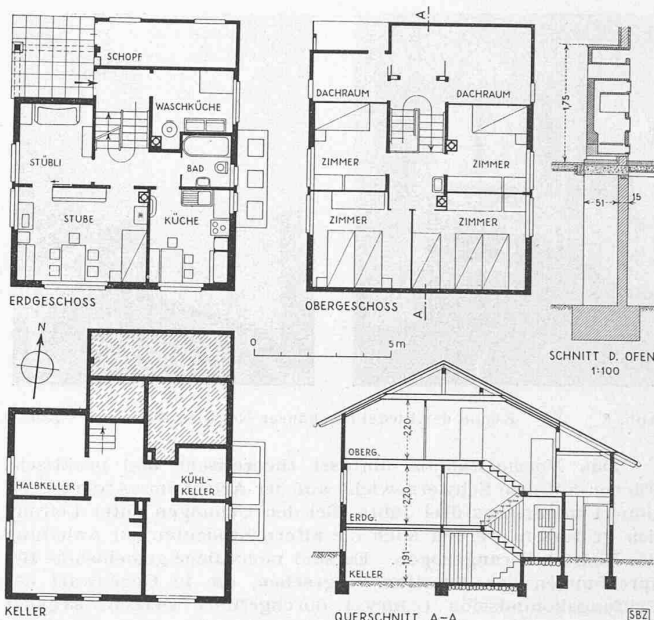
Grundrisse und Schnitt 1:250 vom grösseren Typ
